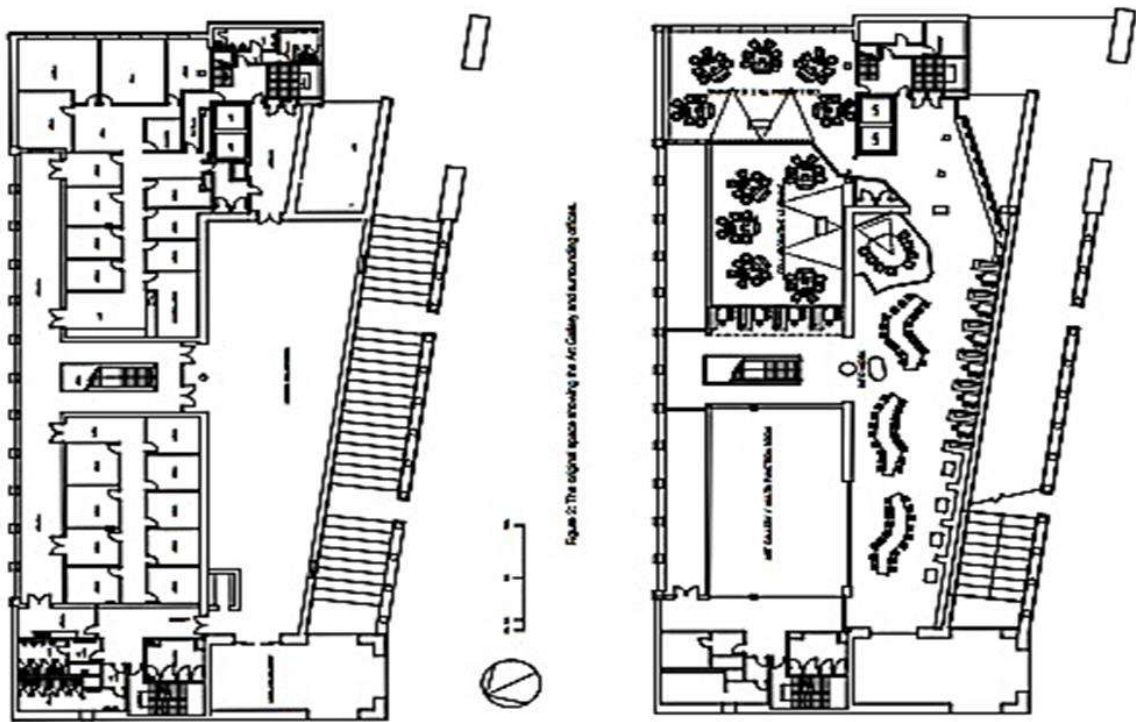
Схема перепланування типового поверху університетської будівлі (рисунок автора)
